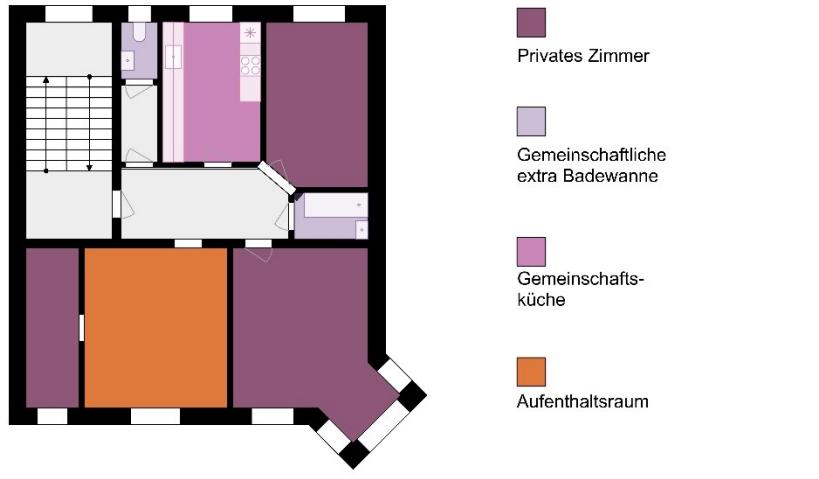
Bestandsgrundriss Wohnung mit drei privaten Zimmern
